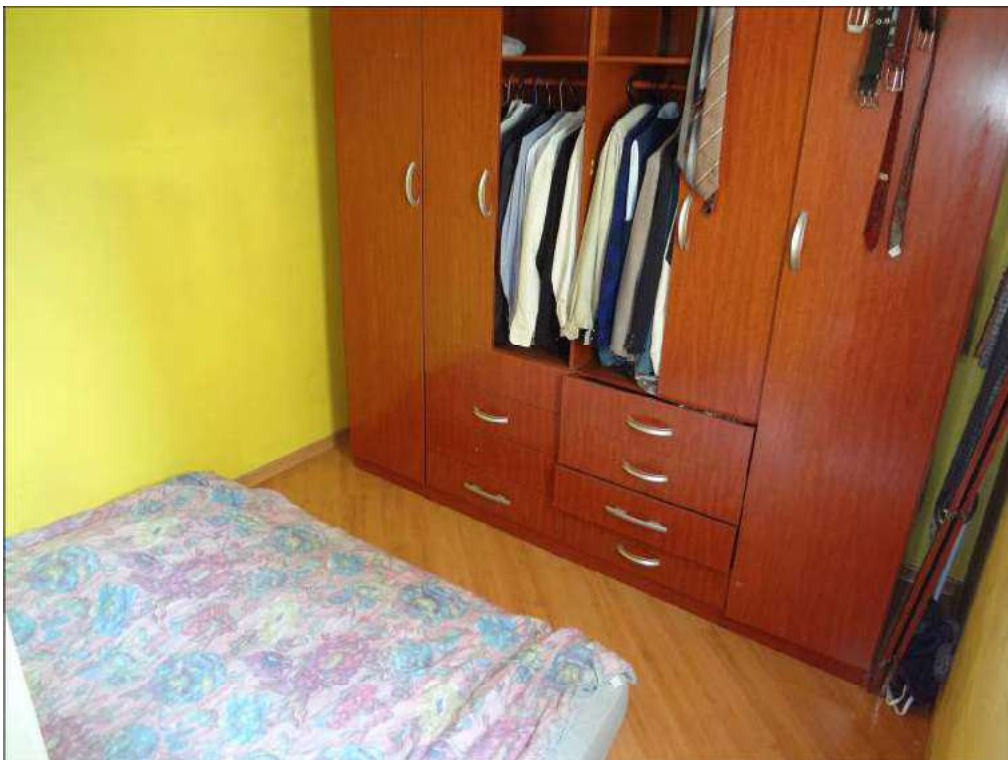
Dormitório 1, destaque para o piso em laminado.
